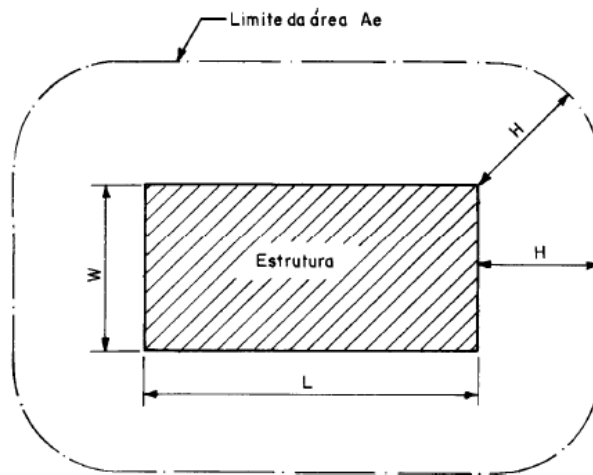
Delimitação da área de exposição equivalente (Ae) - Estrutura vista de planta
